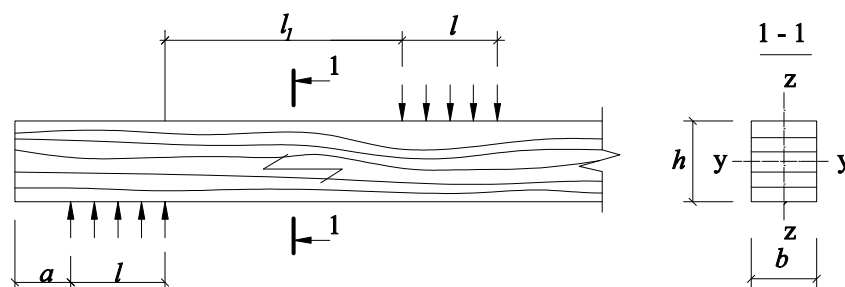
Схема опирания элемента на отдельные опоры
